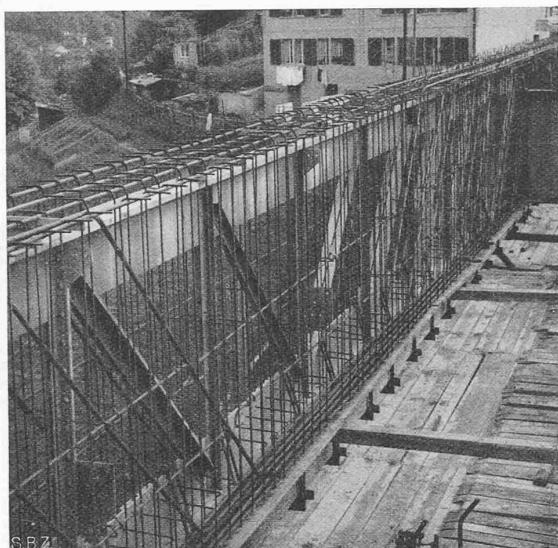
Melanträger Oeffnungen 2 bis 4, mit schlaffen Bewehrungen aus St 37. Flacheisensättel und Bohrungen zum genauen Verlegen der Rundreisen
